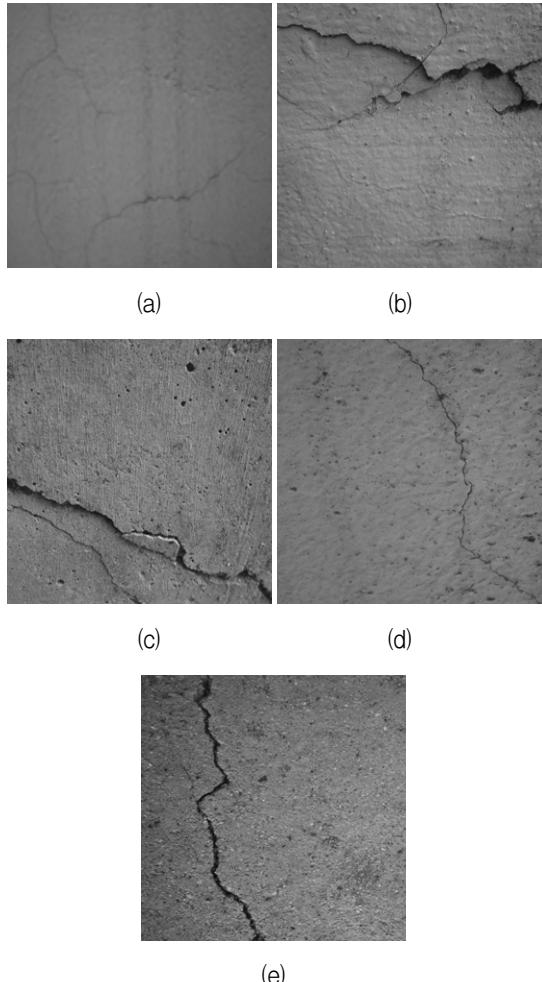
테스트 균열 영상들. (a) Crack1, (b) Crack2, (c) Crack3, (d) Crack4, (e) Crack5
